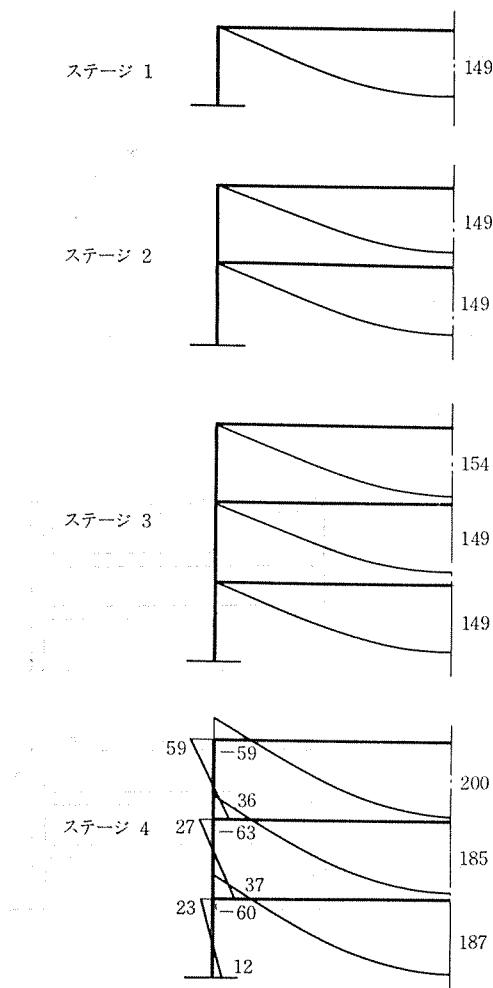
施工段階別鉛直荷重時応力—組立式（単位:t・m）
